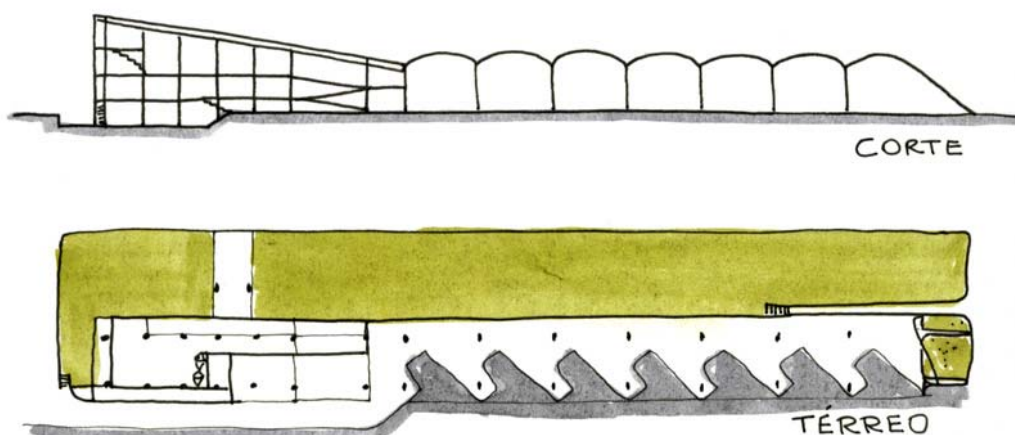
Corte e planta da Rodoviária de Londrina. Fonte: redesenhado a partir de ARTIGAS, Júlio Camargo (2006).
